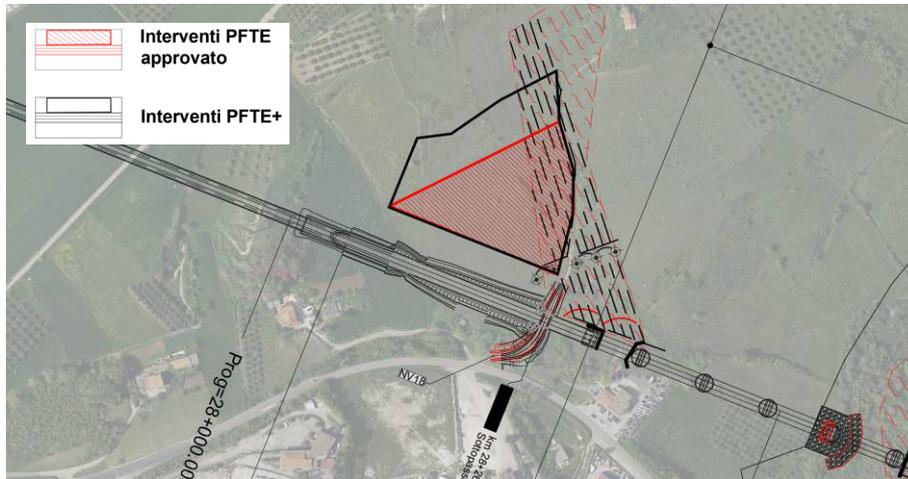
Modifiche all'area di cantiere AS.09. Sovrapposto cantieri con il sistema dei vincoli (in rosso il PFTE e in nero il PFTE+)
